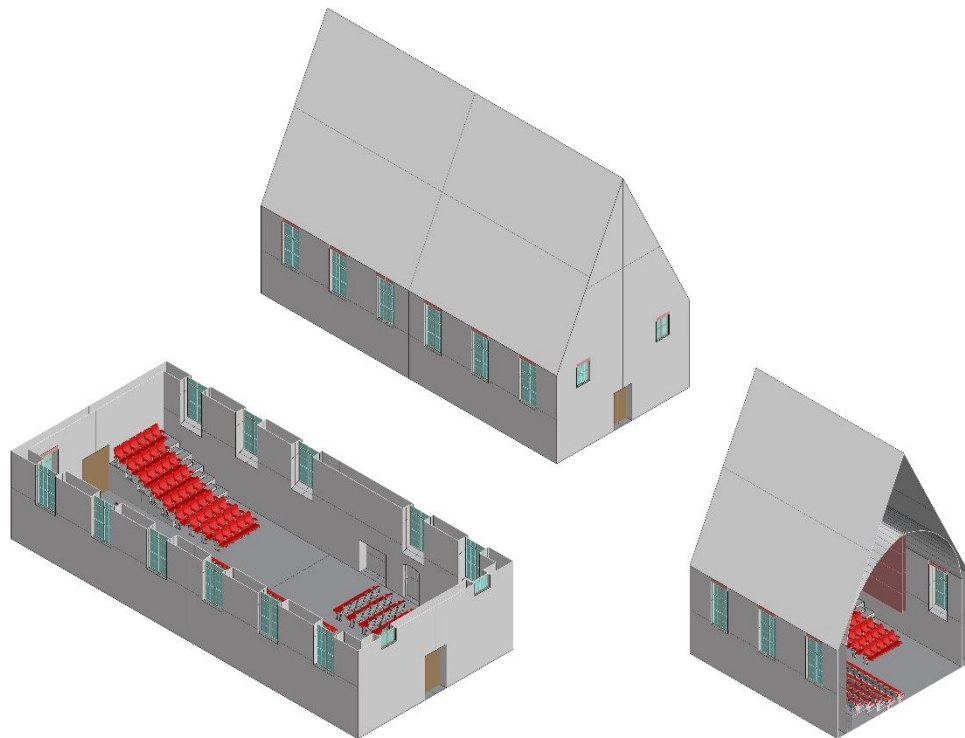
Vistas en axonometría del modelo de la sala Kraakhuis, vista completa, sección plano horizontal y sección plano vertical. Fuente: elaboración propia.
